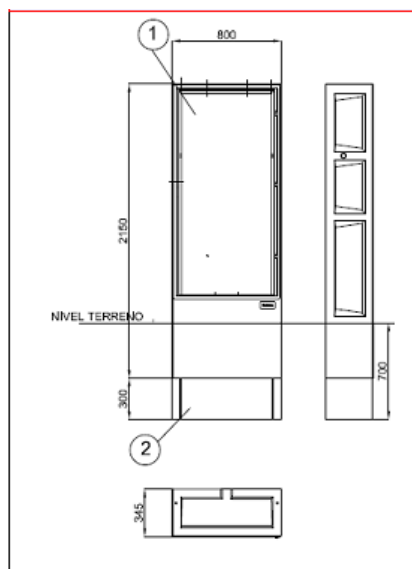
Detall armari prefabricat instal·lació d'enllaç
